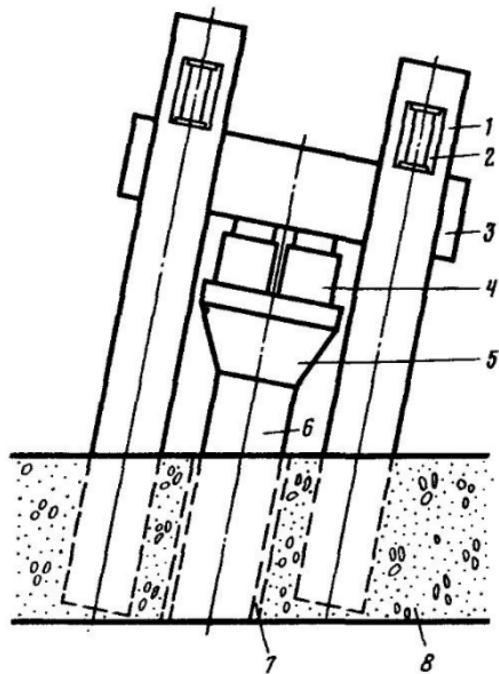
Установка для испытания вдавливающей нагрузкой наклонного свайного элемента в опоре:
